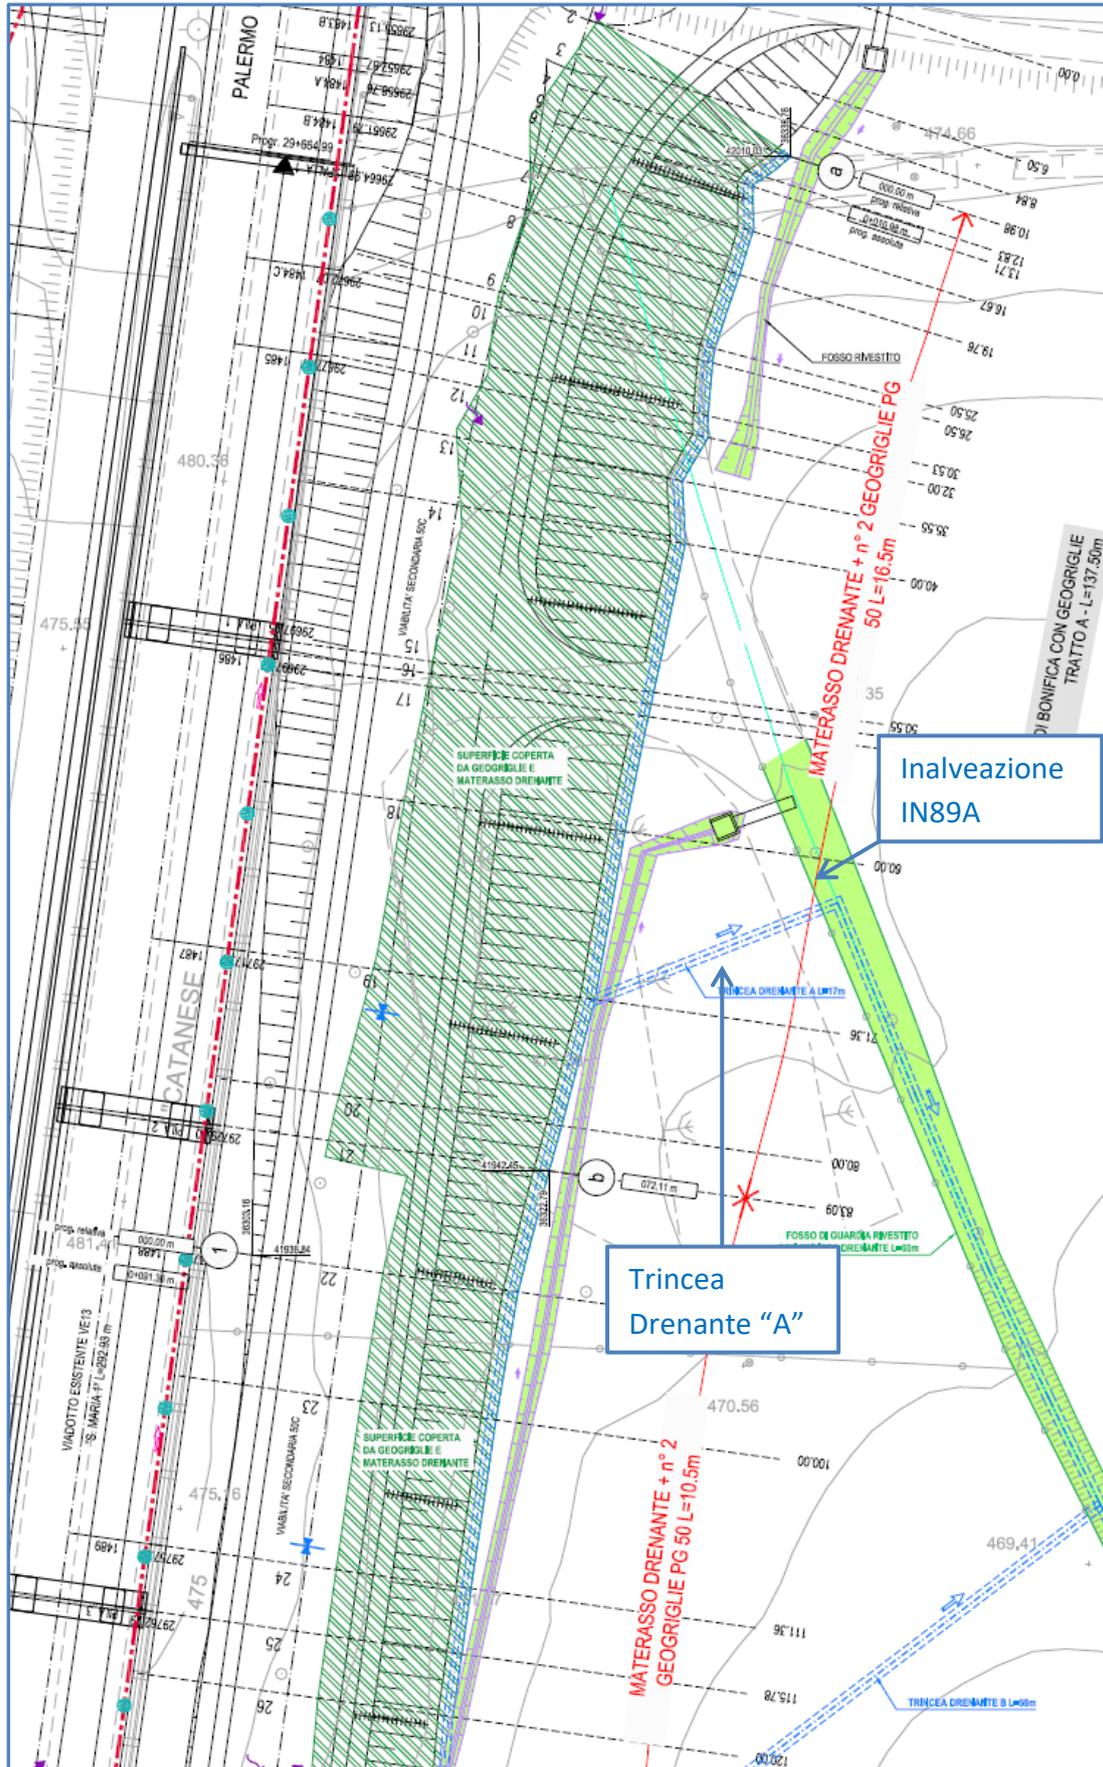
Stralcio planimetrico di progetto (Elab. Codifica PVOS117A\_N001\_51\_4137).
